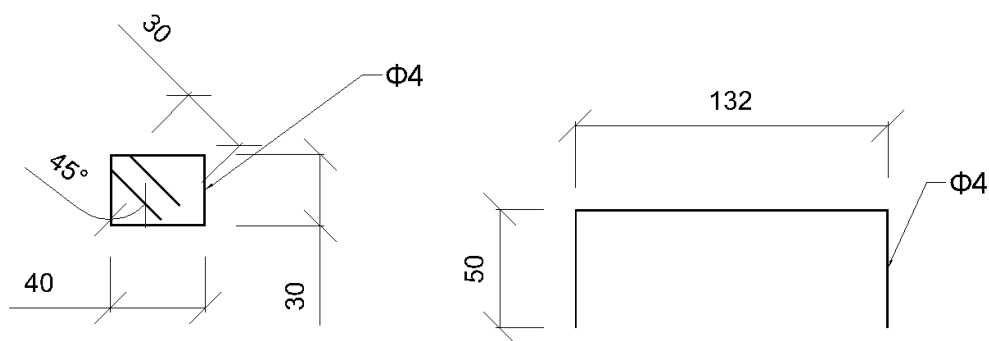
Detalle de Estribos de Confinamiento y Armadura de Corte (dimensiones exteriores [mm]).
